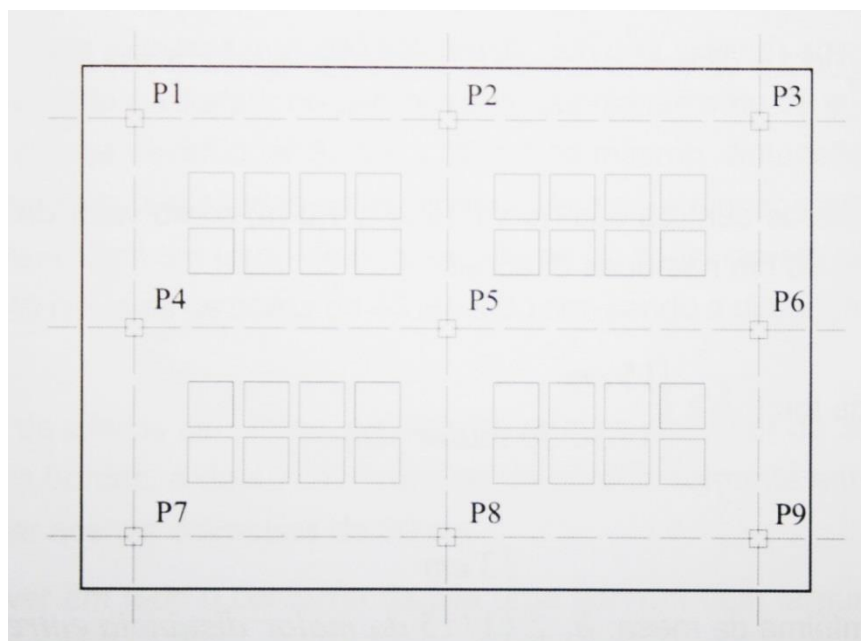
Pavimento de laje sem vigas em faixas, seguindo as direções dos pilares (CARVALHO e PINHEIRO, 2009).
